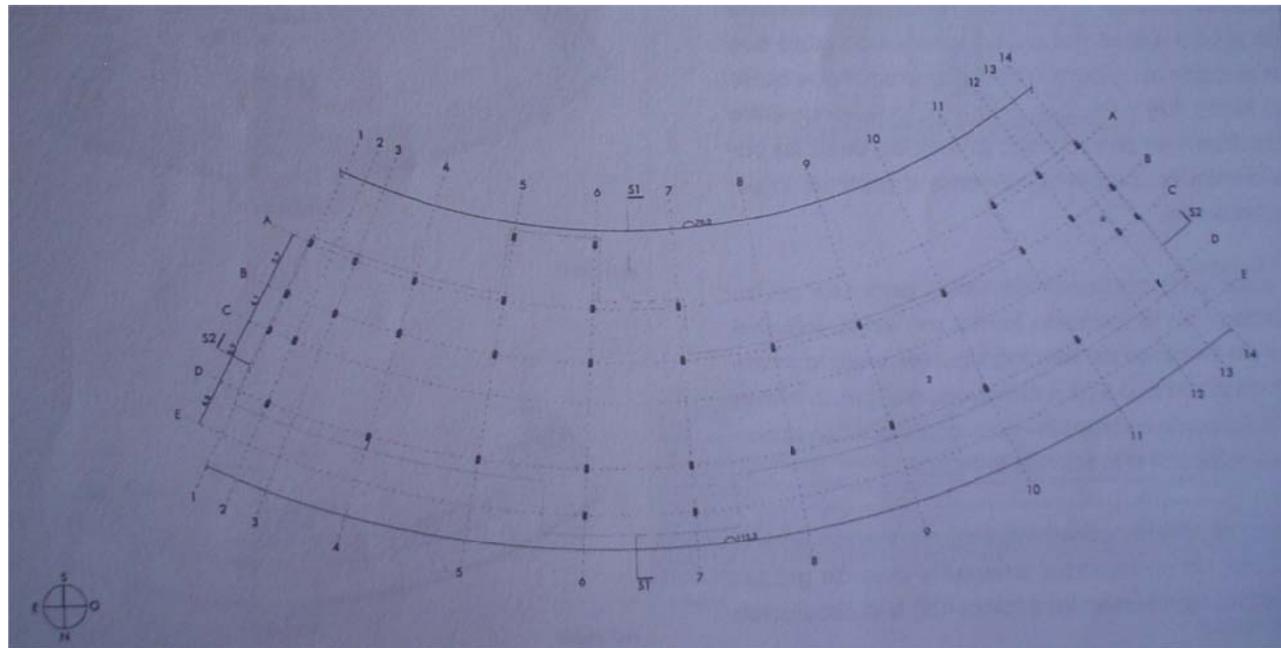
Planta Estructural del edificio. Fuente: Tesis Lata Guamán, Oswaldo. ALAMIRO GONZÁLEZ. OBRAS Y PROYECTOS ENTRE 1960-1970
